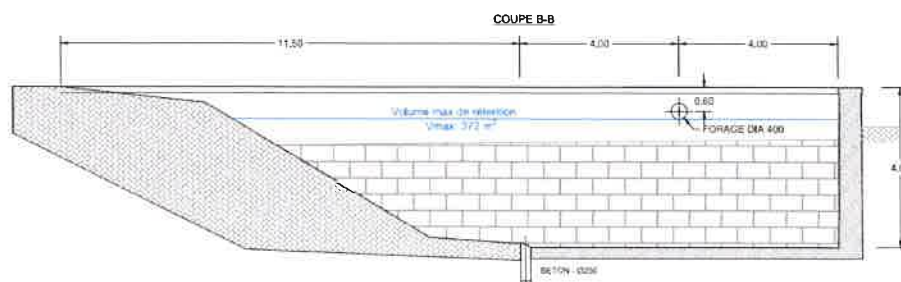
Extrait de l'annexe 1 : coupe transversale de l'ouvrage
